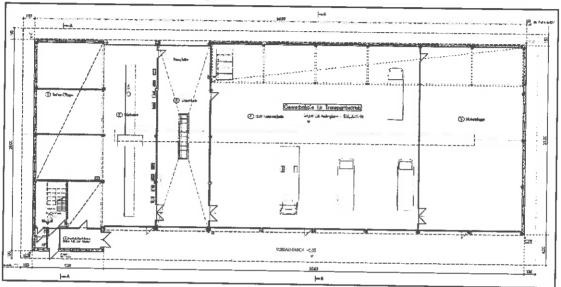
Grundriss Gewerbehalle für Transportbetrieb, Landbau Süd, Ingenieurbüro Fertigbau GmbH, Aalen vom 06.06./22.11.2018
